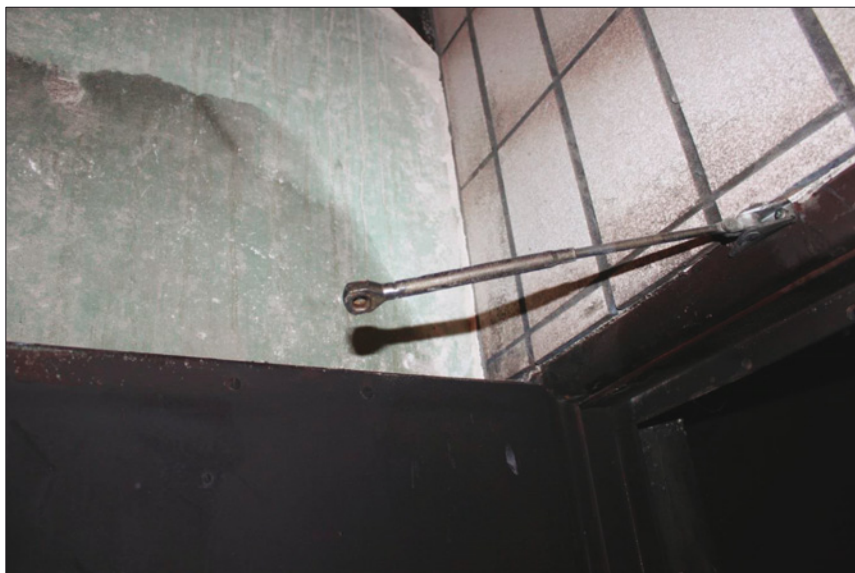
Obentürschließer (Die Tür war offen – Indiz für mangelhaften Umfang mit dem Objekt)
